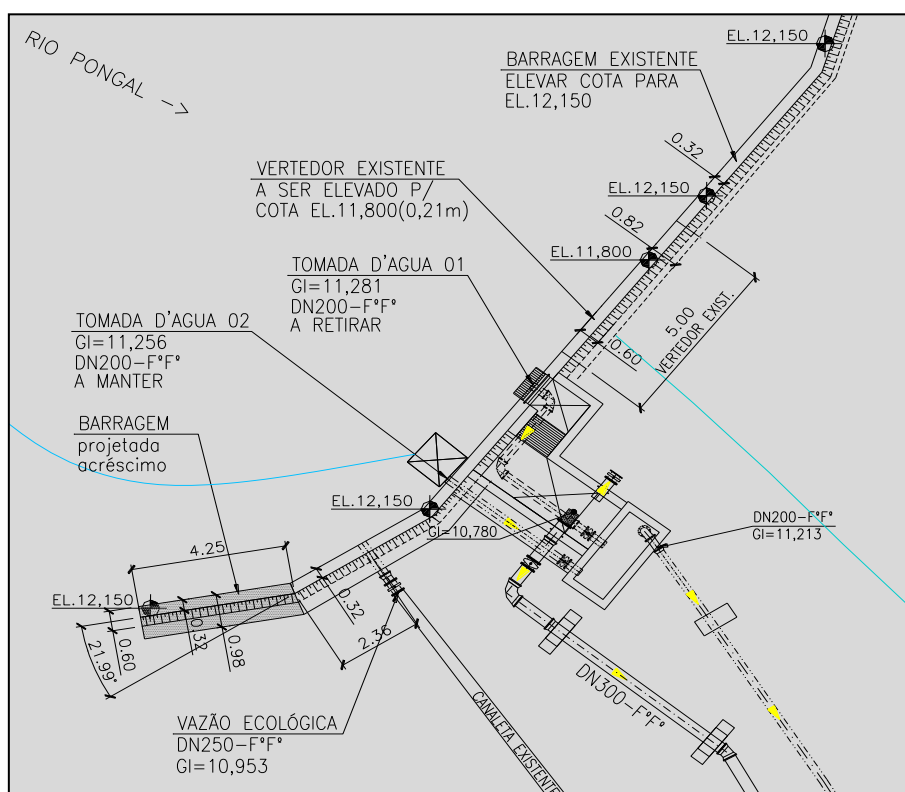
Planta baixa de parte da barragem, e trecho a ser construído.
